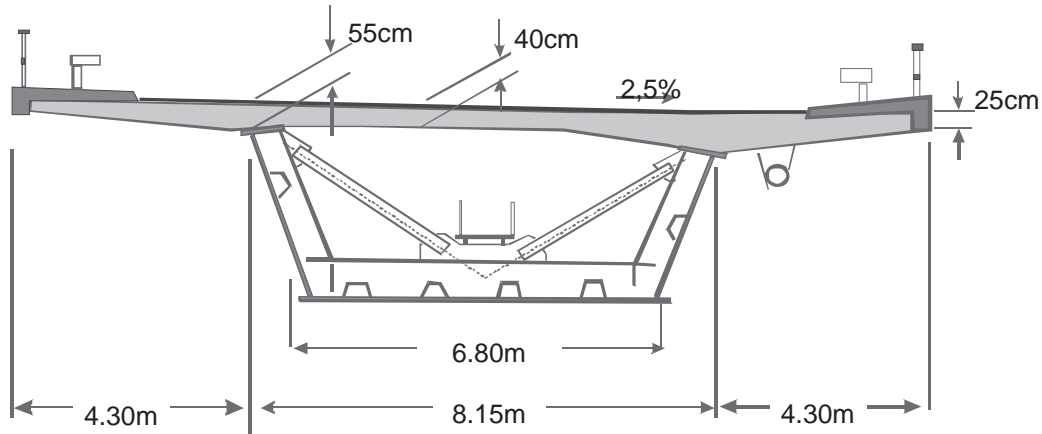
Section transversale typique d'un pont caisson mixte allemand avec augets [39].
